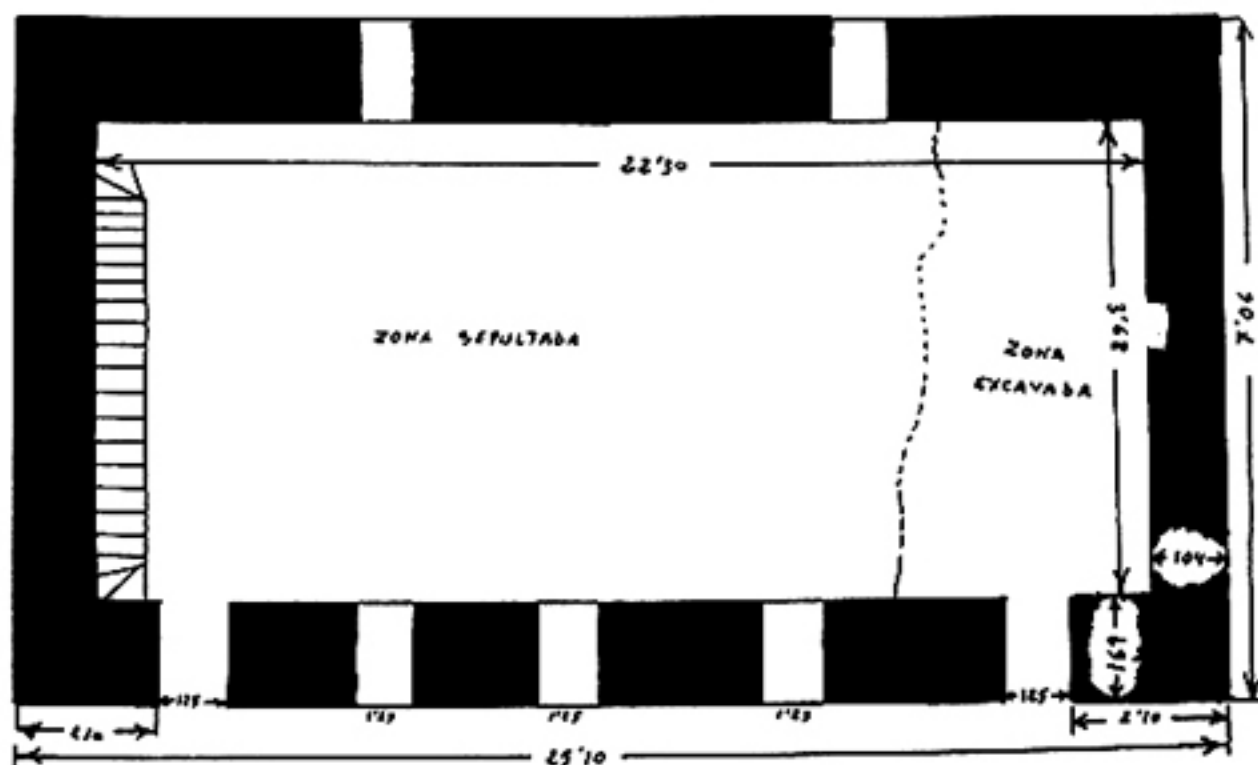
Plano de planta y medidas lineales del viejo Hospital que se construyó por los franceses. Tenía una superficie útil por planta de 82 m.² aprox. (Plano del autor).
